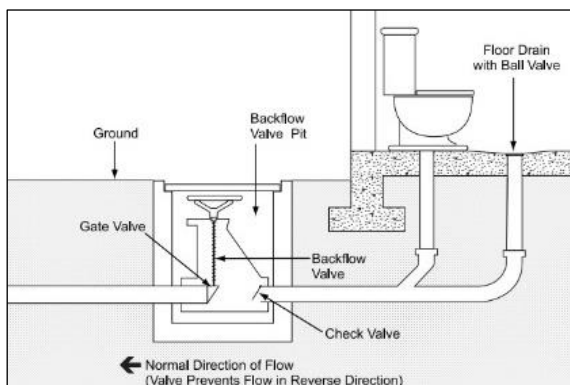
Válvulas antirretorno. Homeowner's Guide to Retrofitting. Six Ways to Protect Your Home From Flooding. FEMA.
